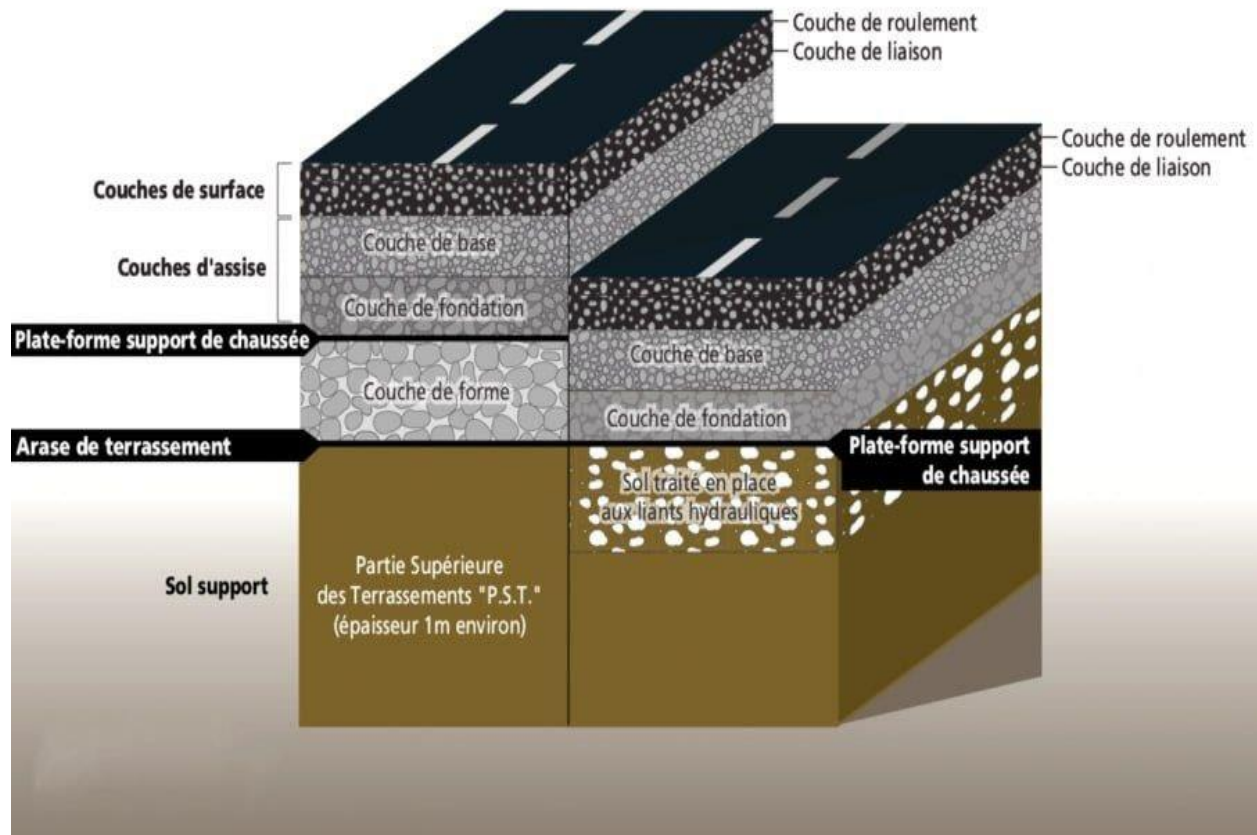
Différentes couches qui constituent la structure de la chaussée
